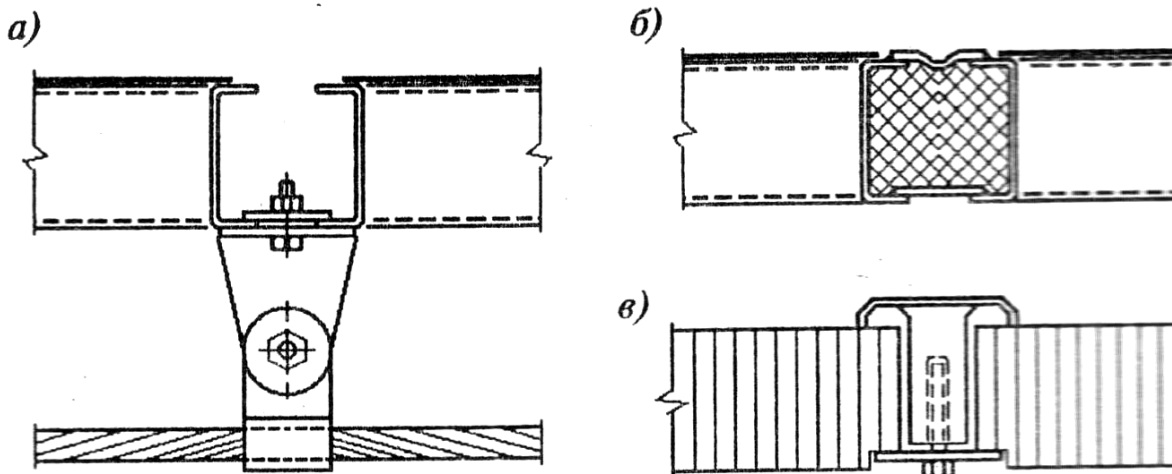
Детали стыков плит: а – опирание плит на столлик; б – сварной стык стальных плит; в – стык с нащельником для стеклопластиковых плит
